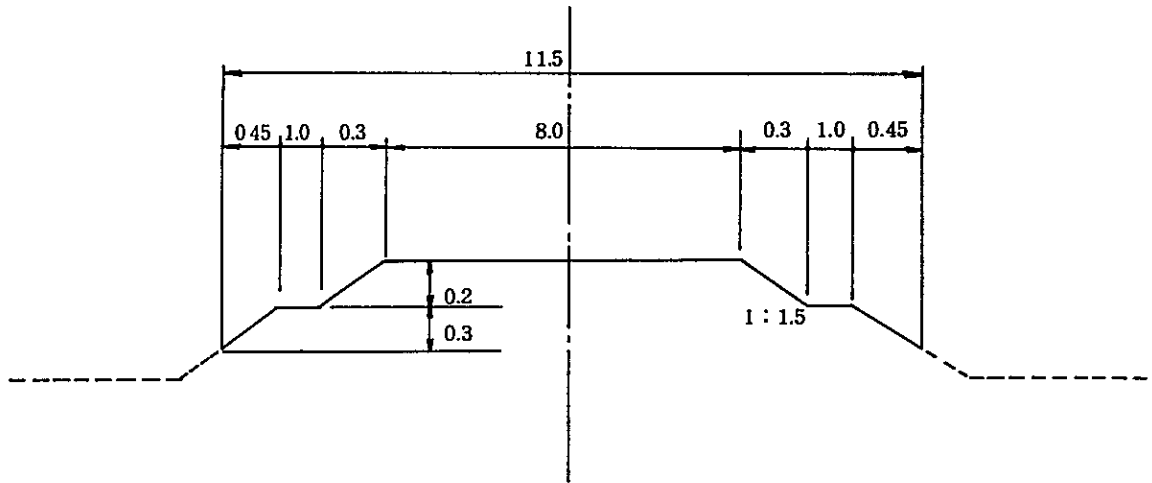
3 - 9 Secondary Road Standard Section (Unit : m)
